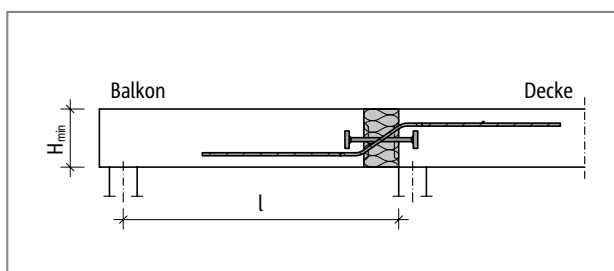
Schöck Isokorb® Typ QPXT: Statisches System
